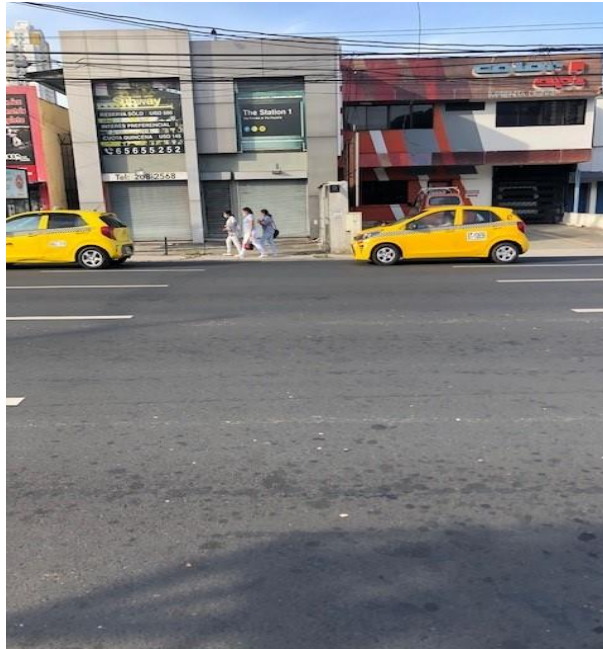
Vista frontal de la fachada del inmueble existente en donde se desarrollará el Proyecto Ph The Station. Se trata de la estructura color gris justamente donde pasan los transeúntes entre los dos taxis.
